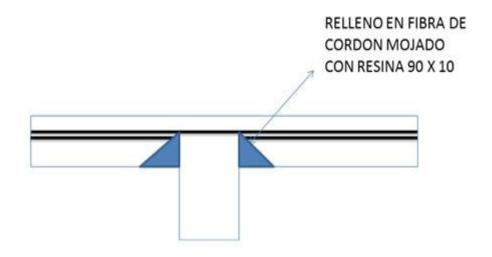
110: Recubrimiento de la Estructura Metálica - Proyecto PTAR
